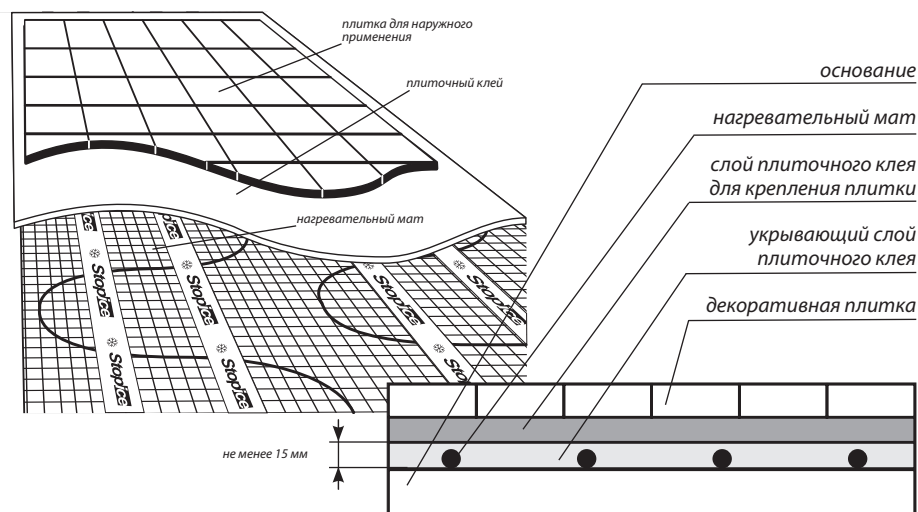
Разрез конструкции обогревательной поверхности с использованием нагревательных матов
